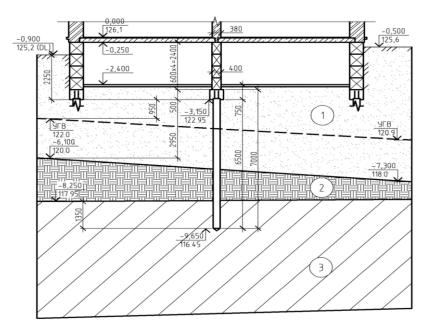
Схема к предварительному выбору свайного фундамента под несущие стены
